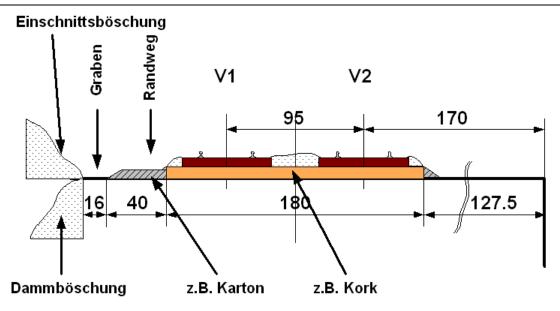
Bahnkörper für zweigleisige Strecke (gerade Strecke)
